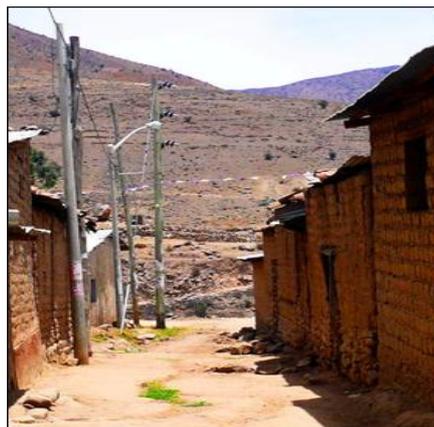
Calle típica con postes de alumbrado en Llauta
